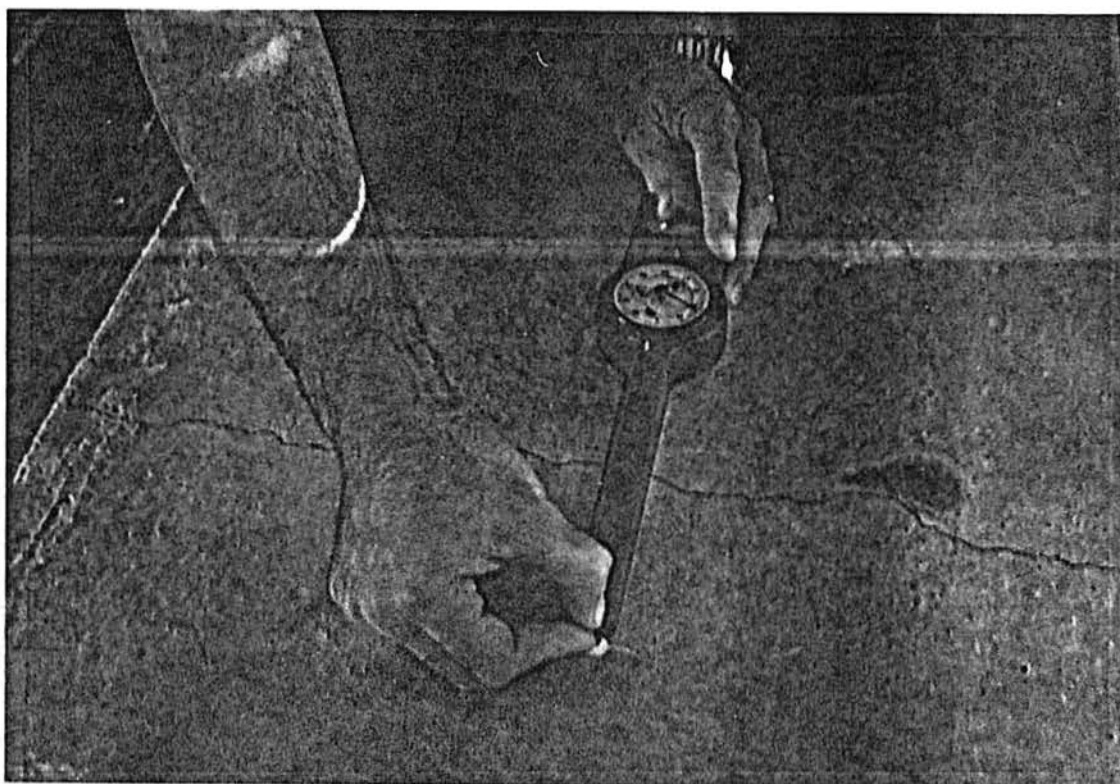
Vista do elongômetro e fissura provocada por retração na secagem do concreto
